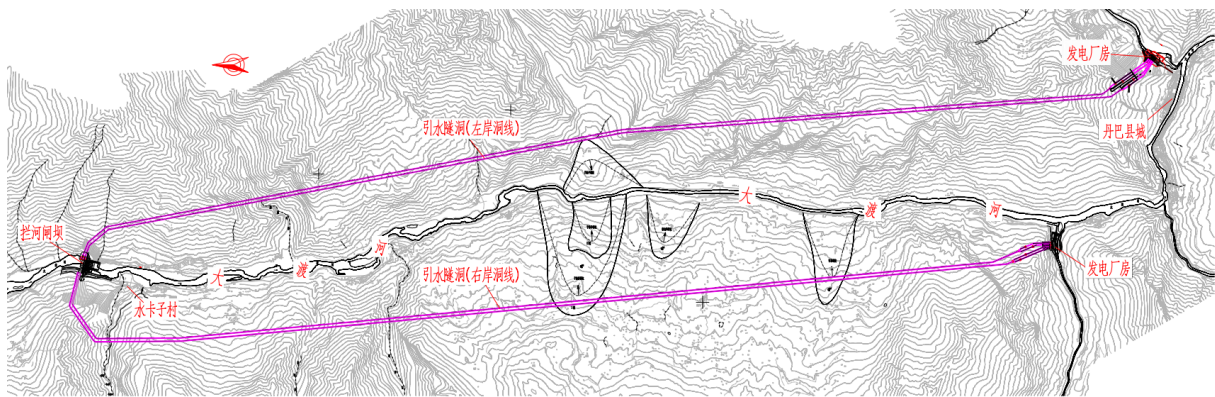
丹巴水电站坝址左右岸引水线路比选平面布置示意图
